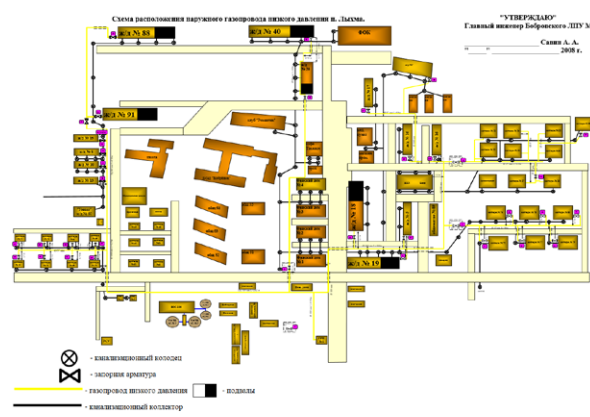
Схема расположения наружного газопровода низкого давления п. Лыхма
